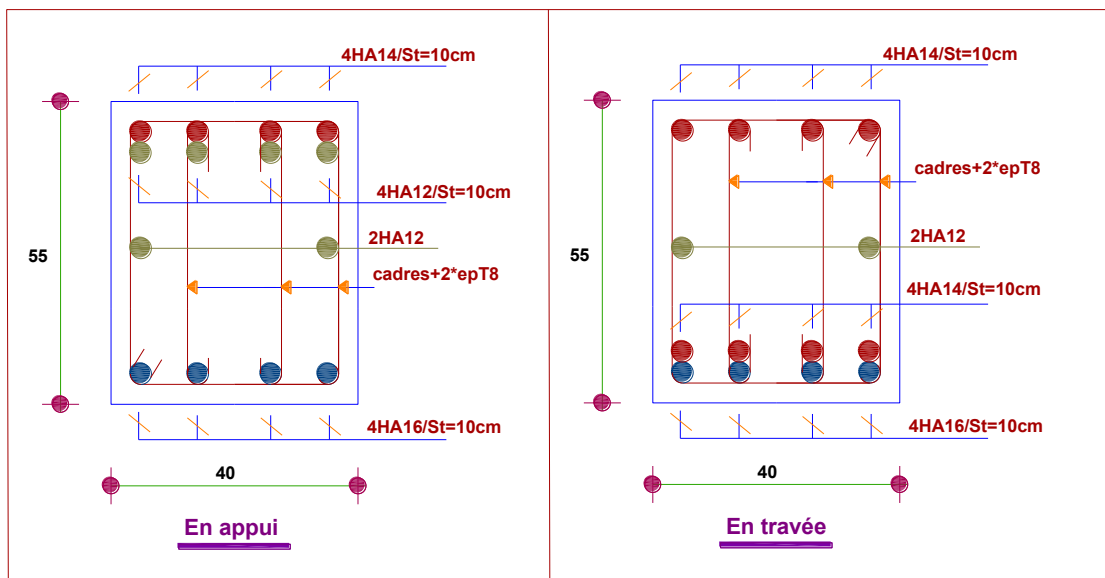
Schémas de ferrailage de la poutre palière 02.
